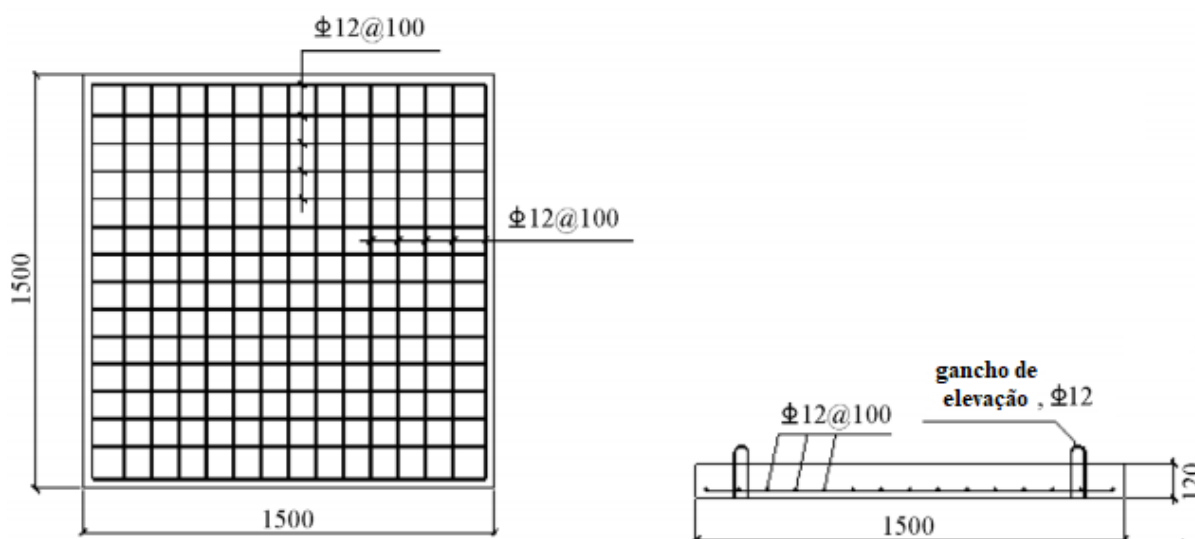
Dimensões da laje e seus reforços (unidade: mm) (Adaptada de XIAO et al., 2019).
